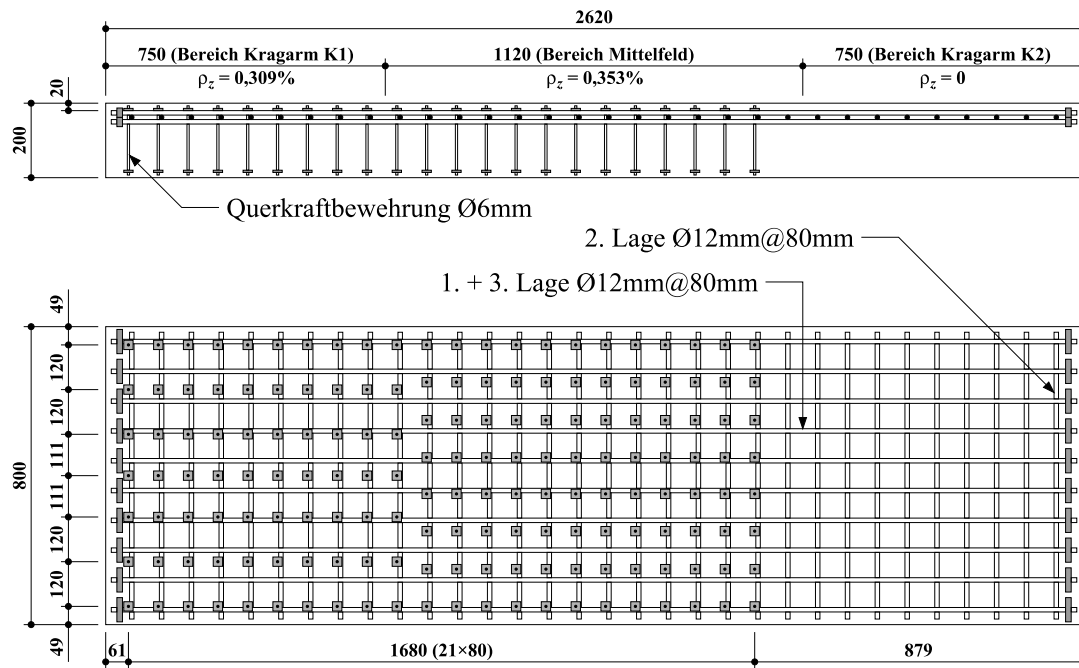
Bewehrungslayout des Plattenstreifens Versuch A3V2, entnommen aus [3]
